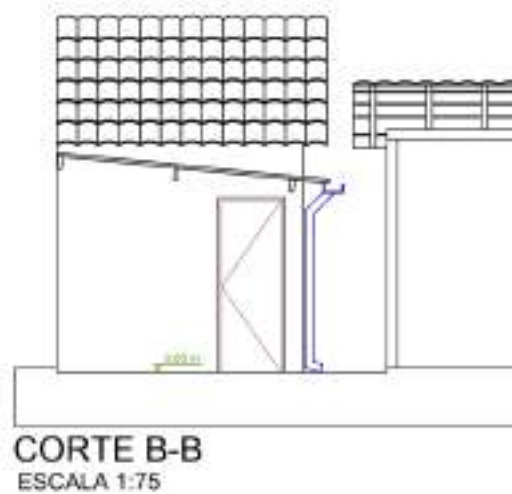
Vista do projeto prevendo a ampliação do telhado.
